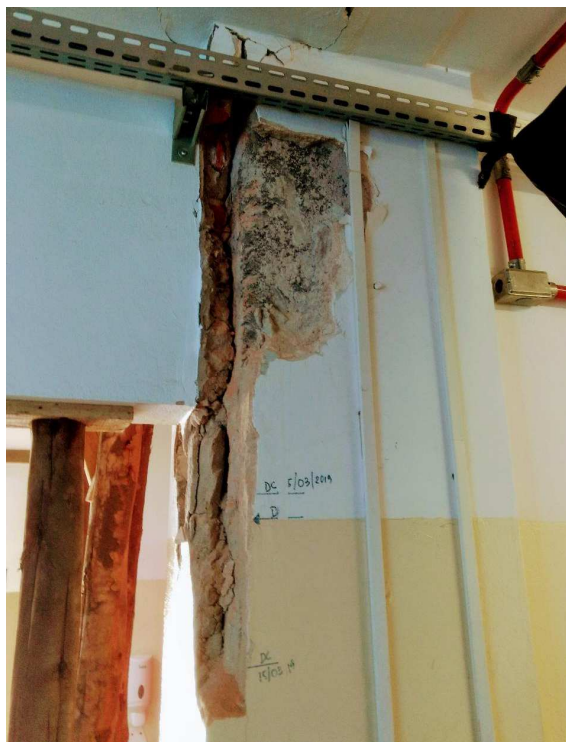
Nota-se a ausência do engastamento entre as peças de concreto.
